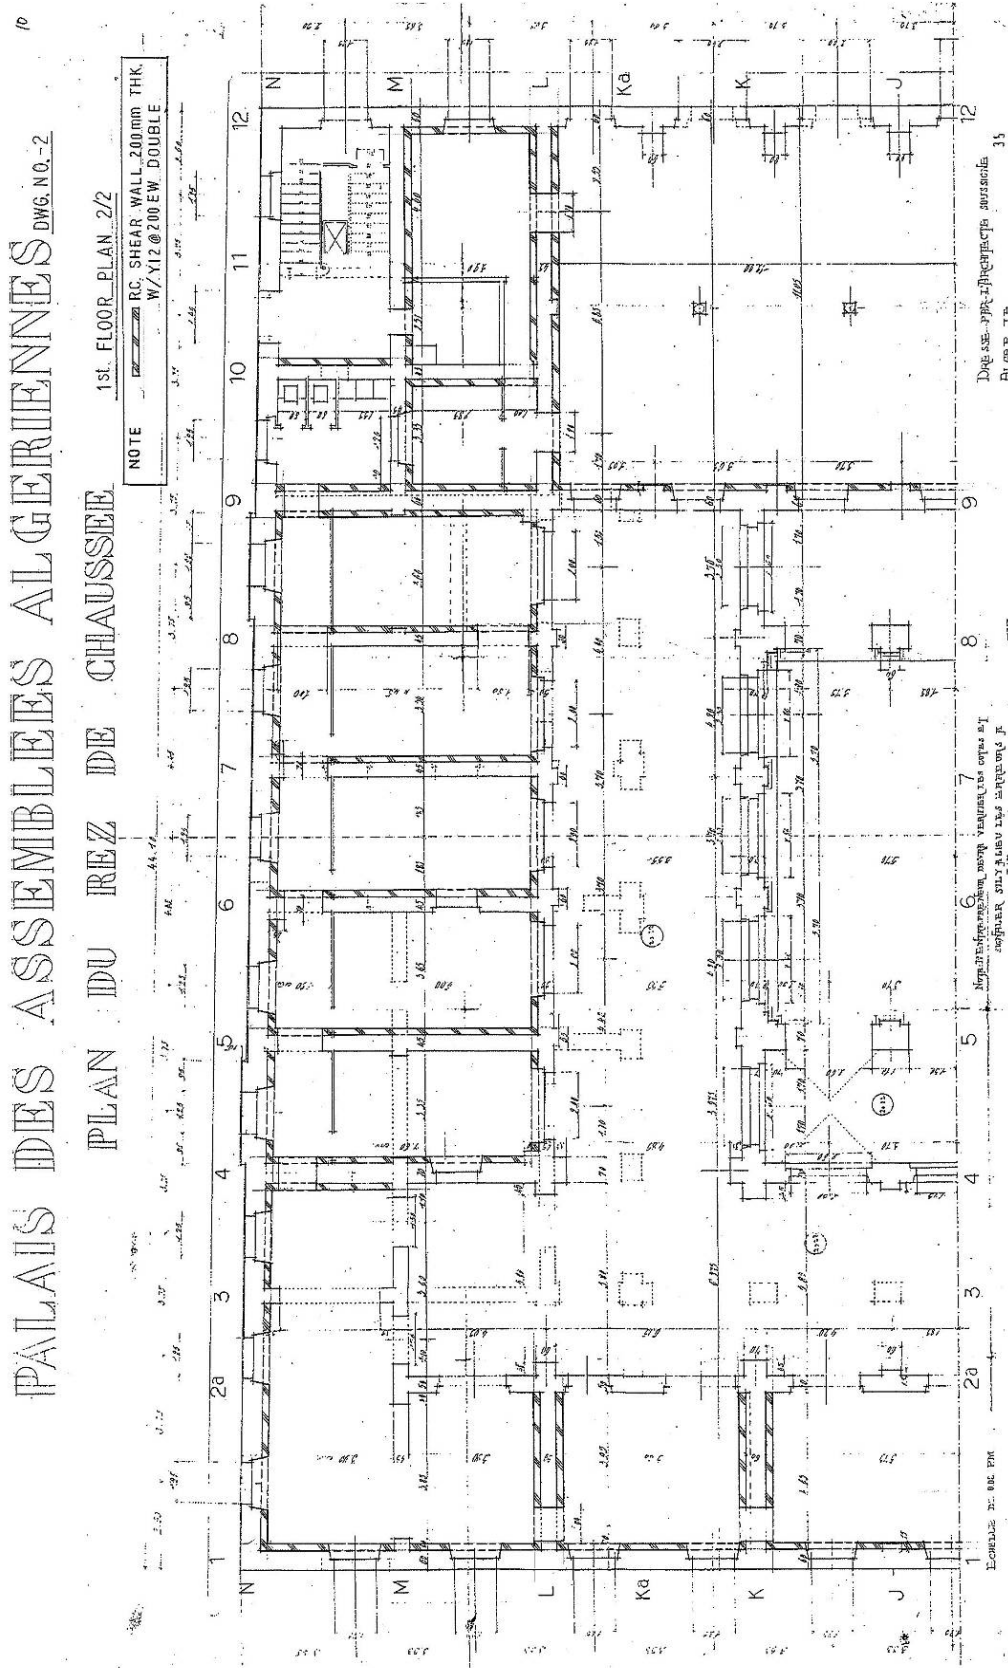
Plan de renforcement du 1er niveau (1/2)
